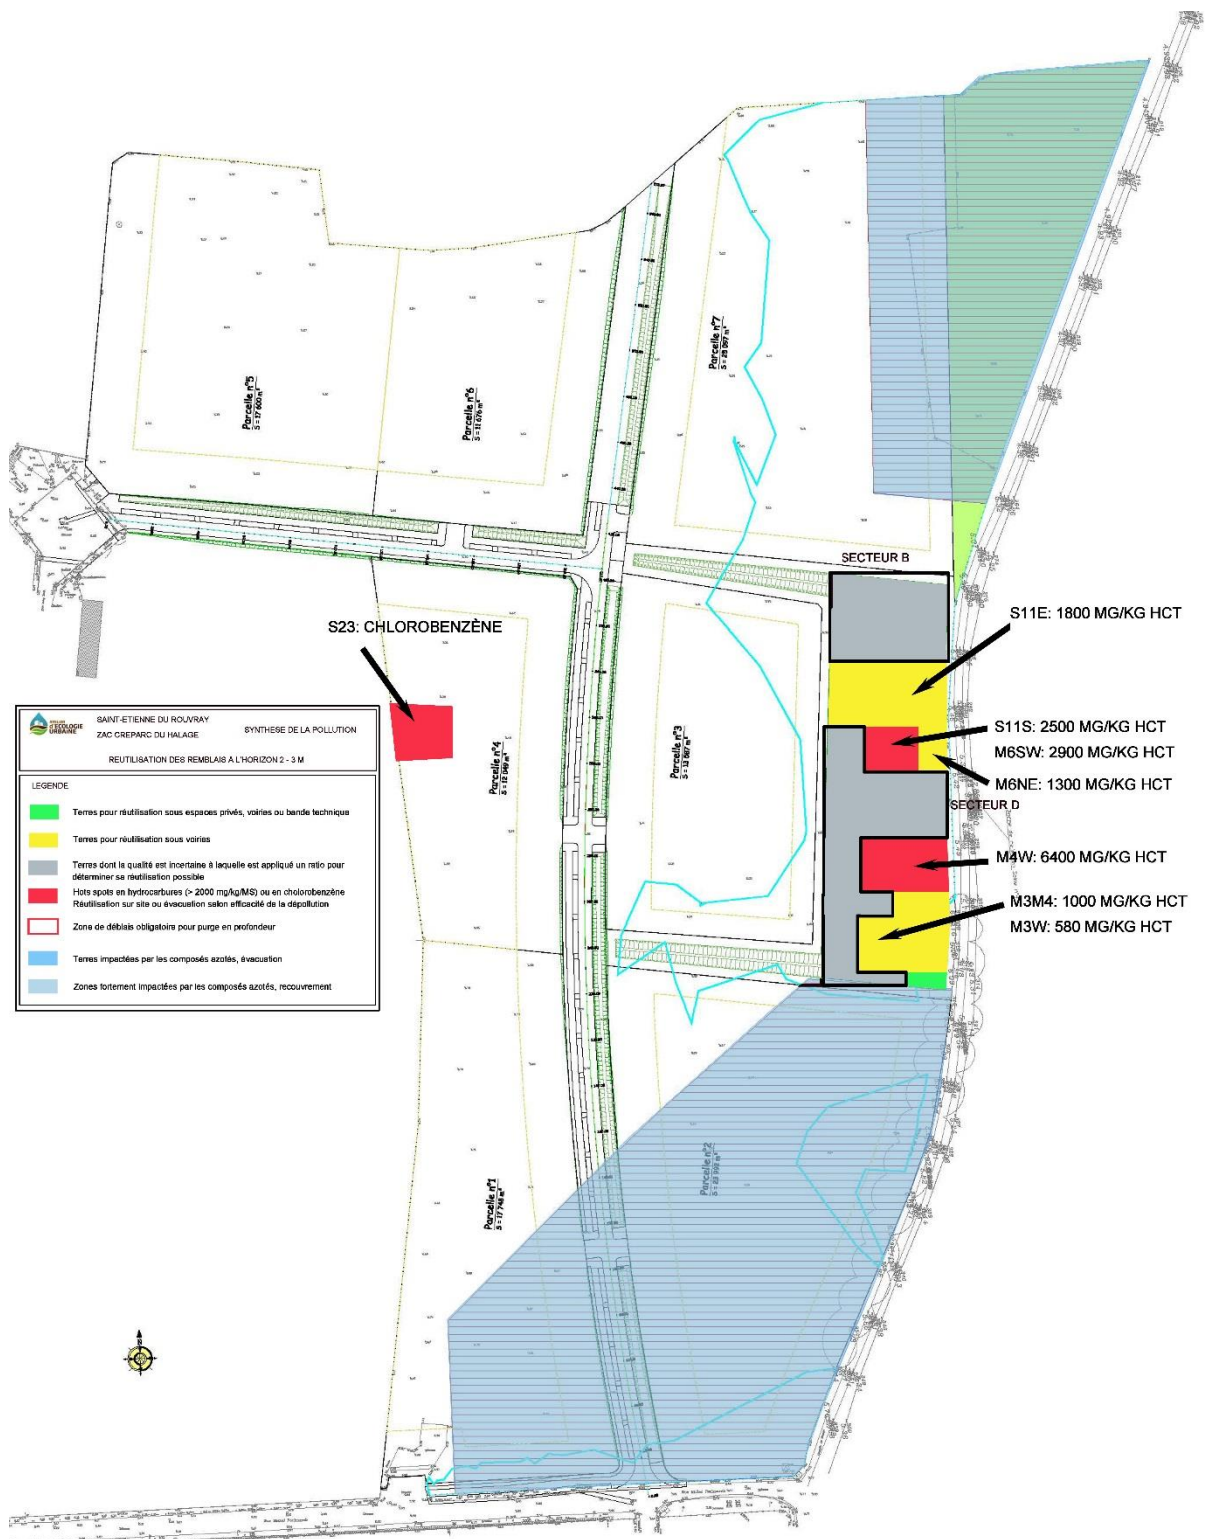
Terrassement et purges sur la profondeur 2-3m
